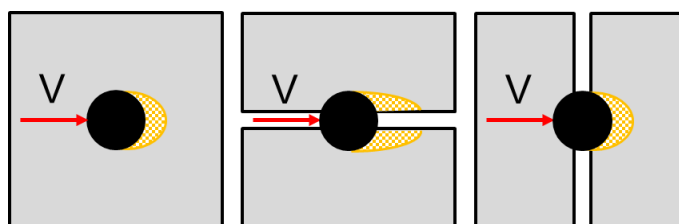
Eindrücken des Ankerbolzens in den Beton bei Querbelastung (links: ungerissener Beton, Mitte: Querbelastung parallel zur Rissebene, rechts: Belastung quer zur Rissebene)
